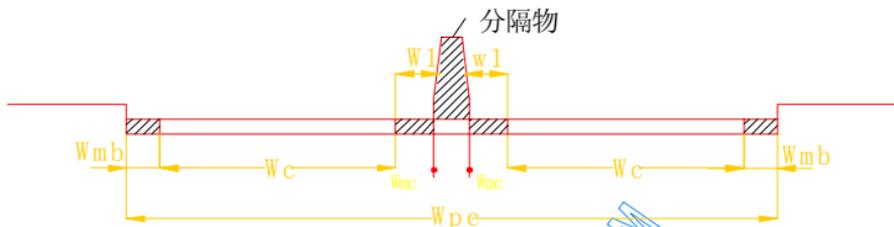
单幅路、三幅路设中间分隔物时横断面布置图
